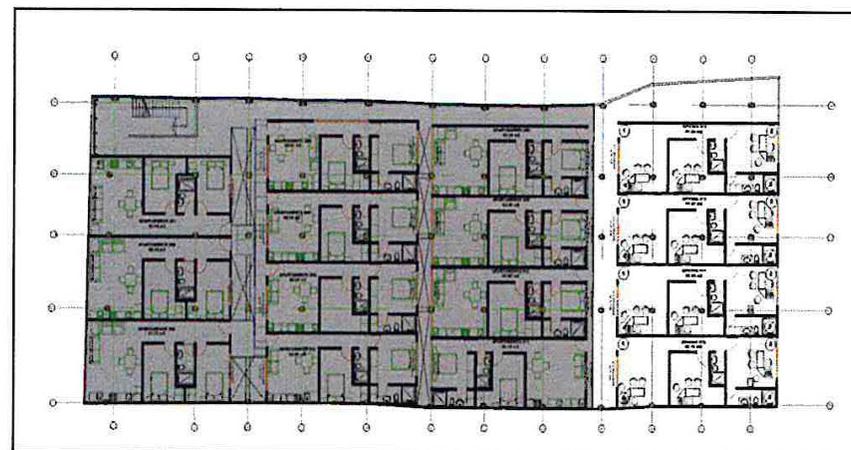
Vista- Planos Arquitectónicos - Proyecto Tercer Piso Tornillería Continental.
